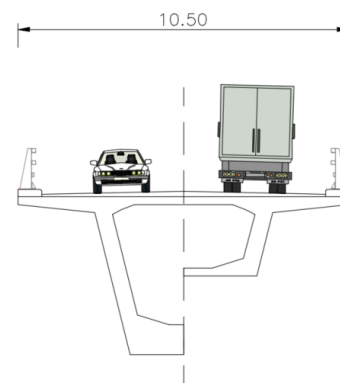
Secciones central y extrema de los puentes sobre el río Chelva
